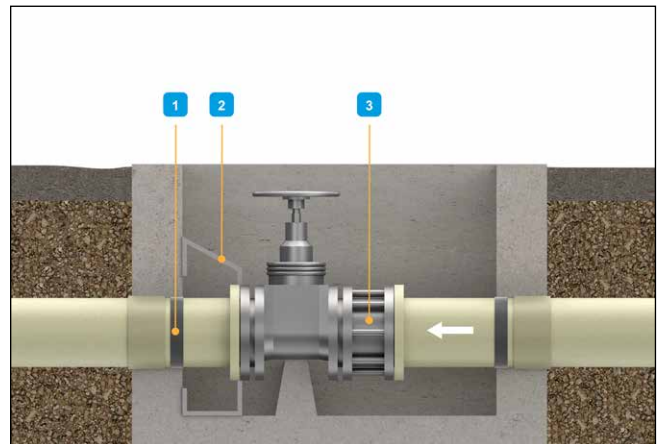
Тип 3 - упорний блок, встановлений поруч із клапаном valve
